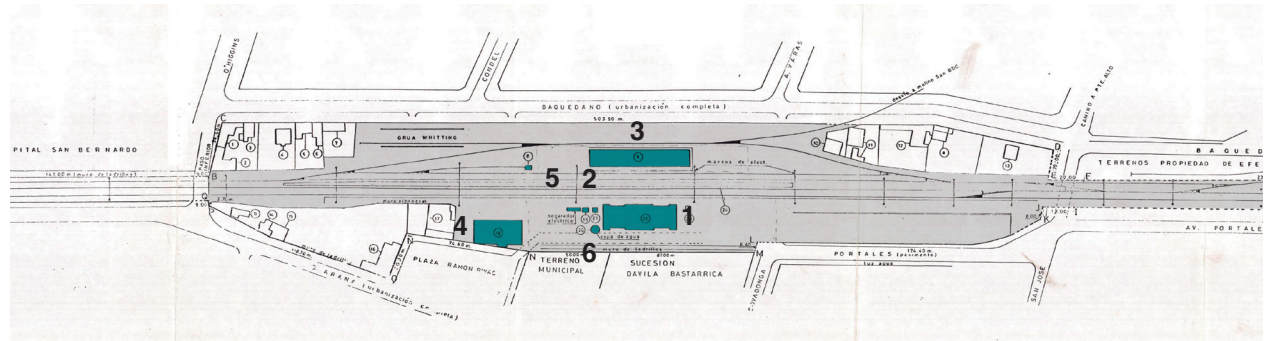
Plano De Terreno De La Estación De Ferrocarriles
